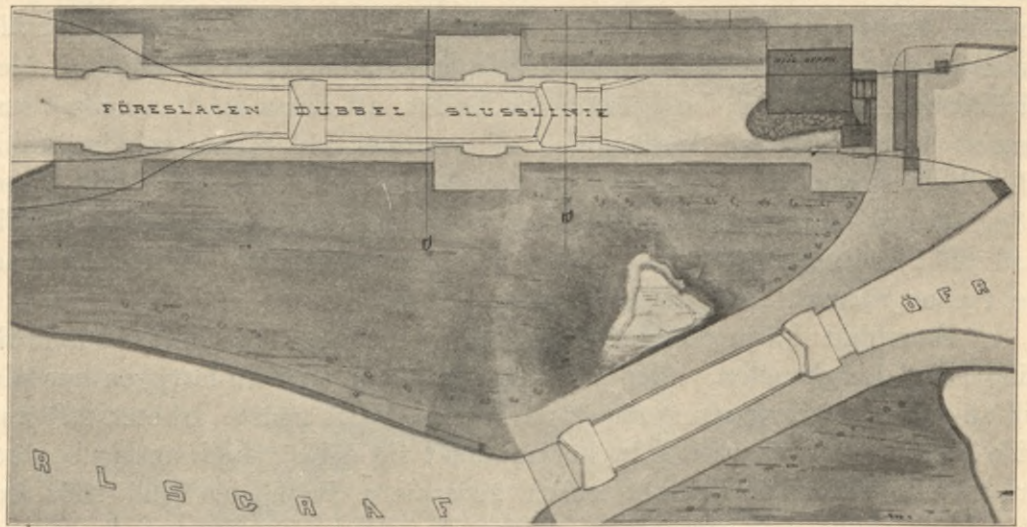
Föreslagen dubbel slusslinje vid öfra slussen vid Brinkebergs kulle. Detalj ur C. Wallströms ritning. Arkivet i Trollhättan.
